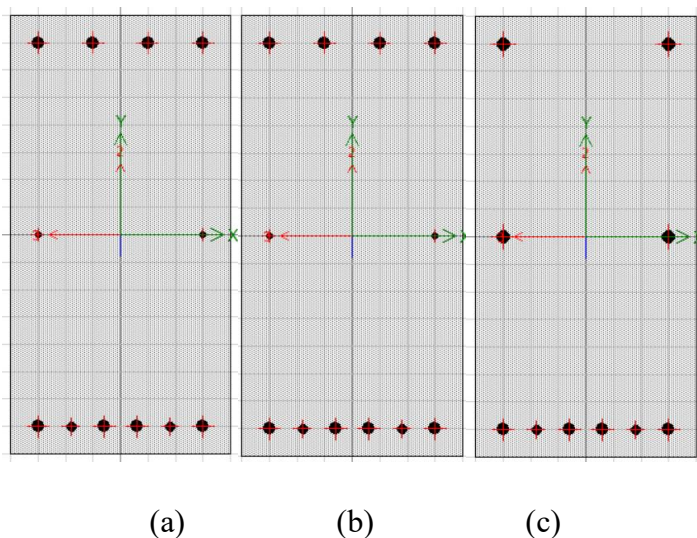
(a) Viga del eje A (b) Viga desde el eje B hasta F (c) Viga del eje G. Todas las vigas son de sección 80x40cm
